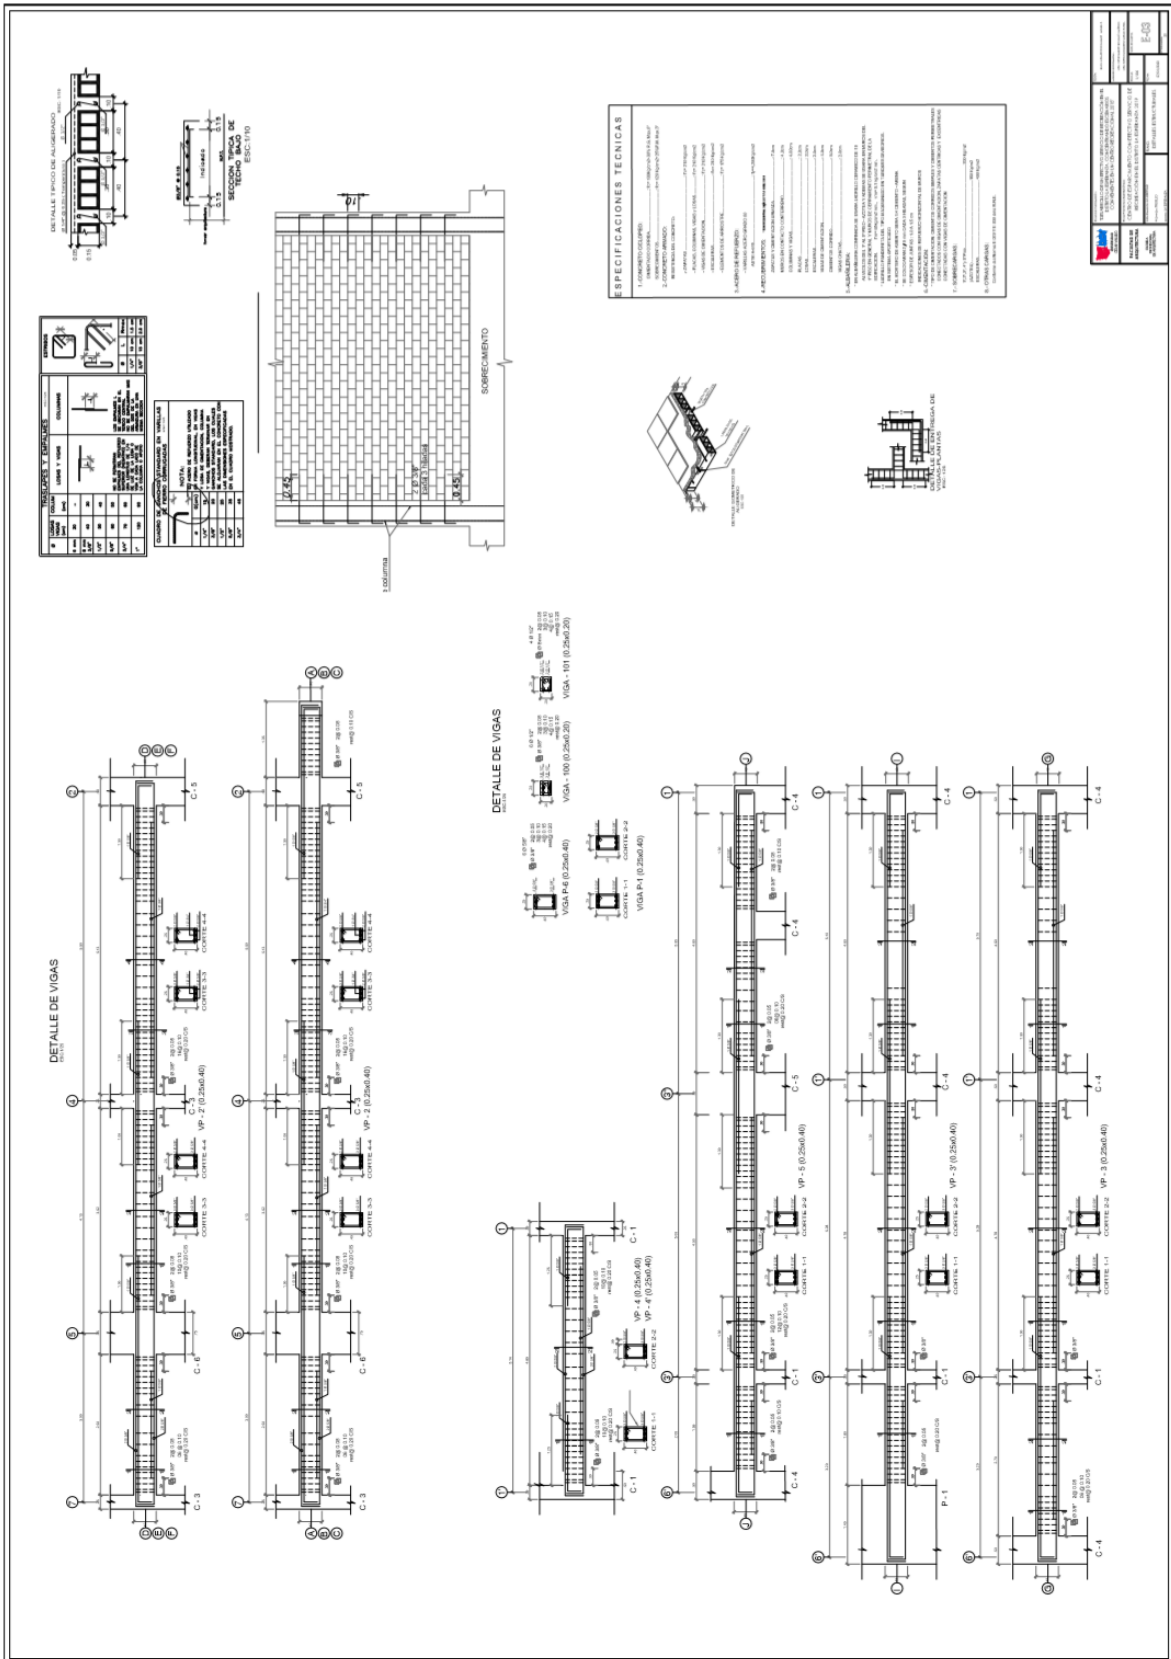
Plano de Restaurante - Aligerado Detalles. Elaboración propia.
